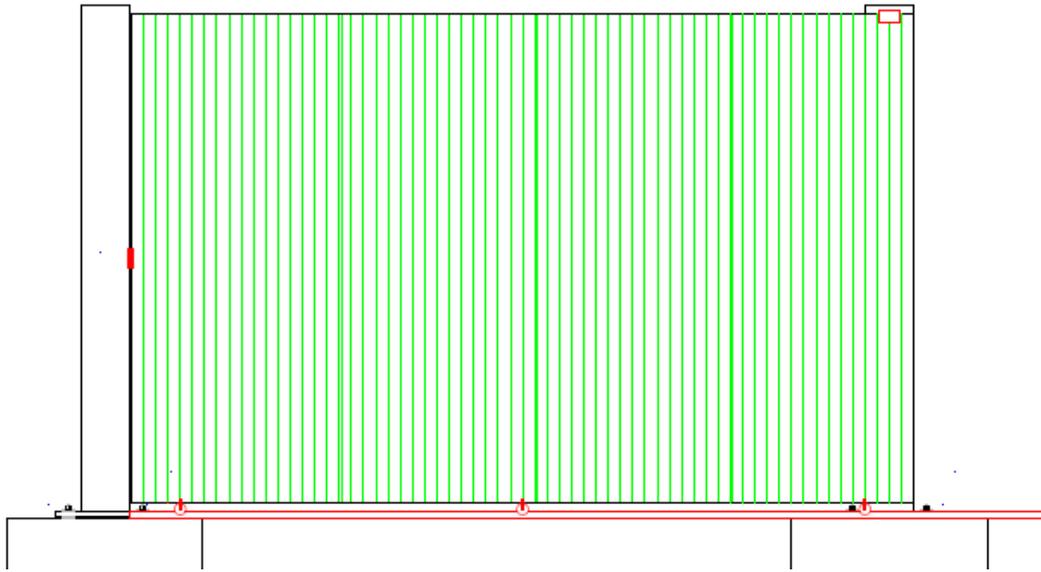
Vista en fachada frontal de la puerta corrediza de garaje.
